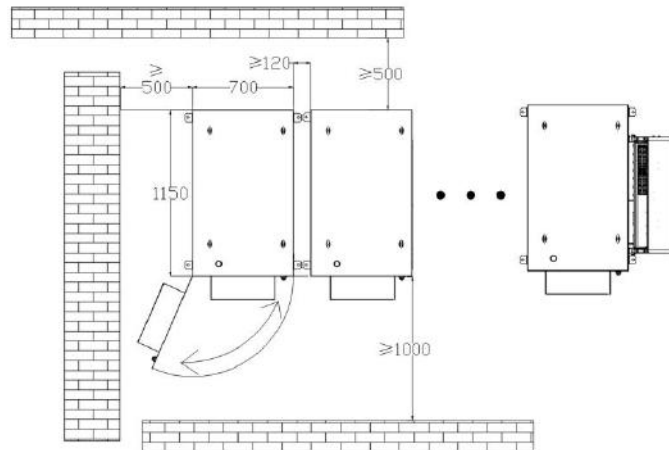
柜体安装间隙示意图（单位 mm）
